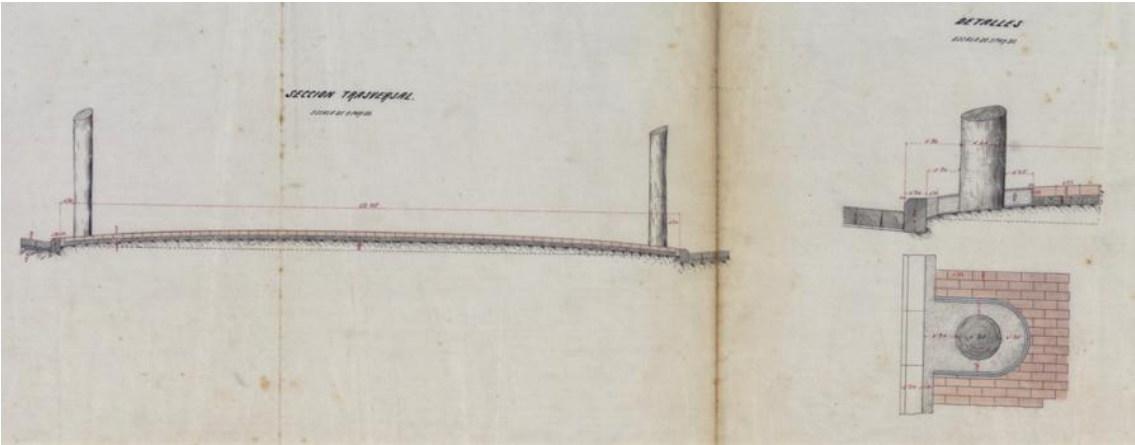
> Plano para la construcción del pavimento de madera en el paseo de la Rambla de Caputxins (Jordan. 1886. En AMCB 1885-86)
